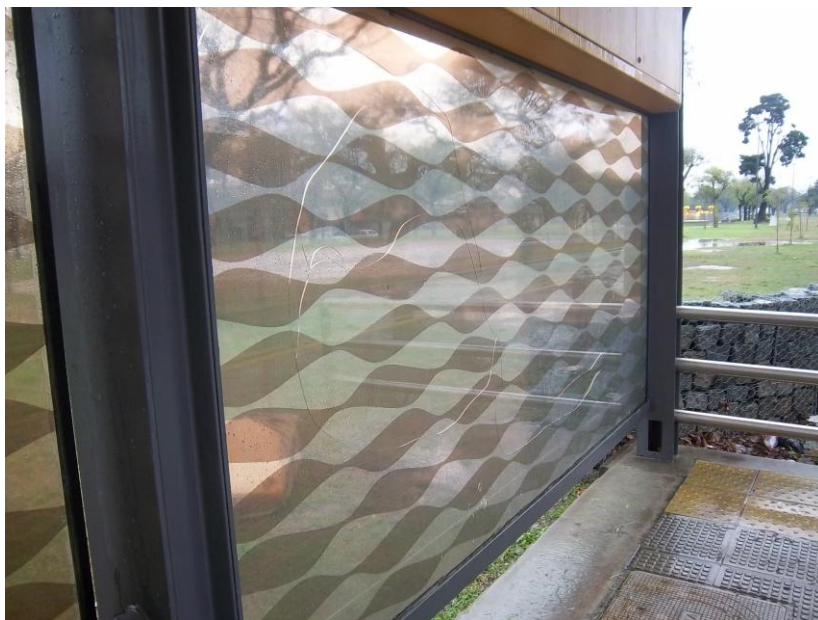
Rotura de Vidrios – Metrobús Corredor Sur
